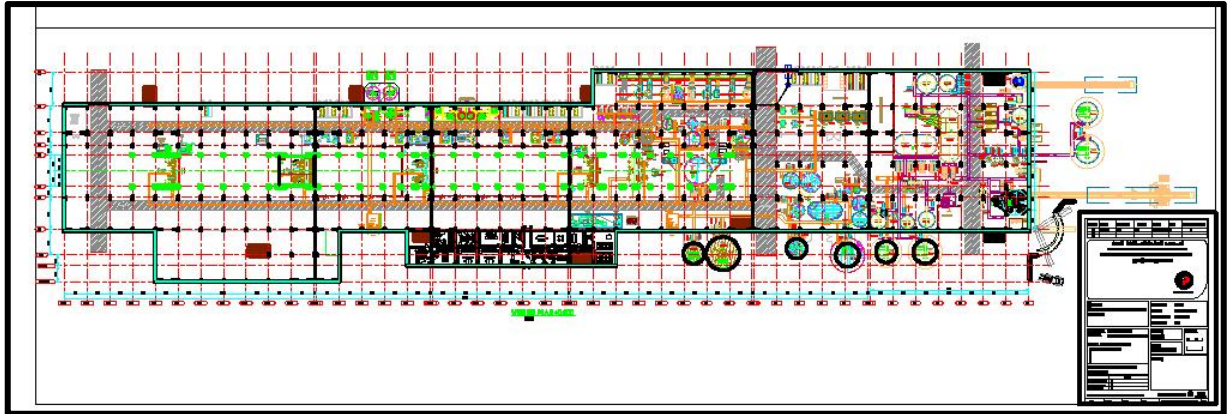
Vue en plan du bloc PM1(GEO5 pile groupe).
